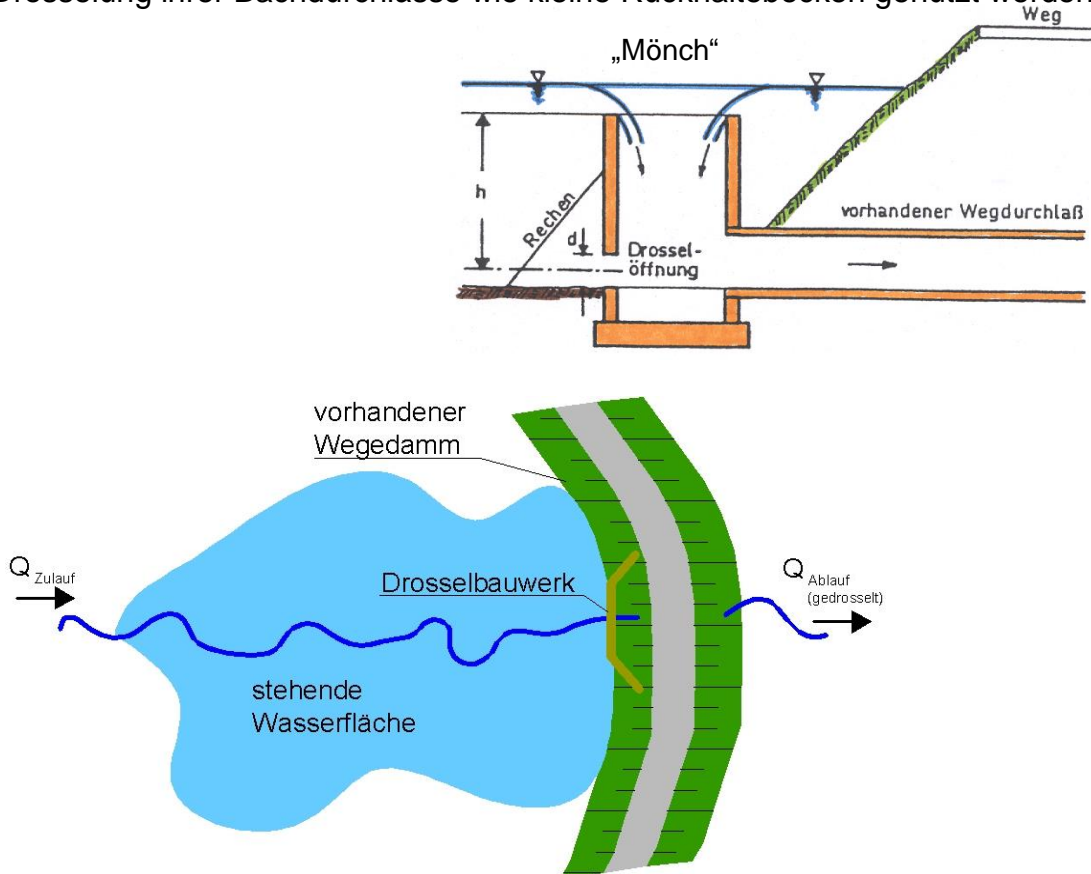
Prinzip des Kleinrückhalts an einem Wegedamm; oben: Durchlassdrossel und Überlauf in einem Schachtbauwerk/Mönch (Schnitt) nach *Mock* (Farbe ergänzt); unten: Grundriss einer Gesamtanlage nach *Kreiter
